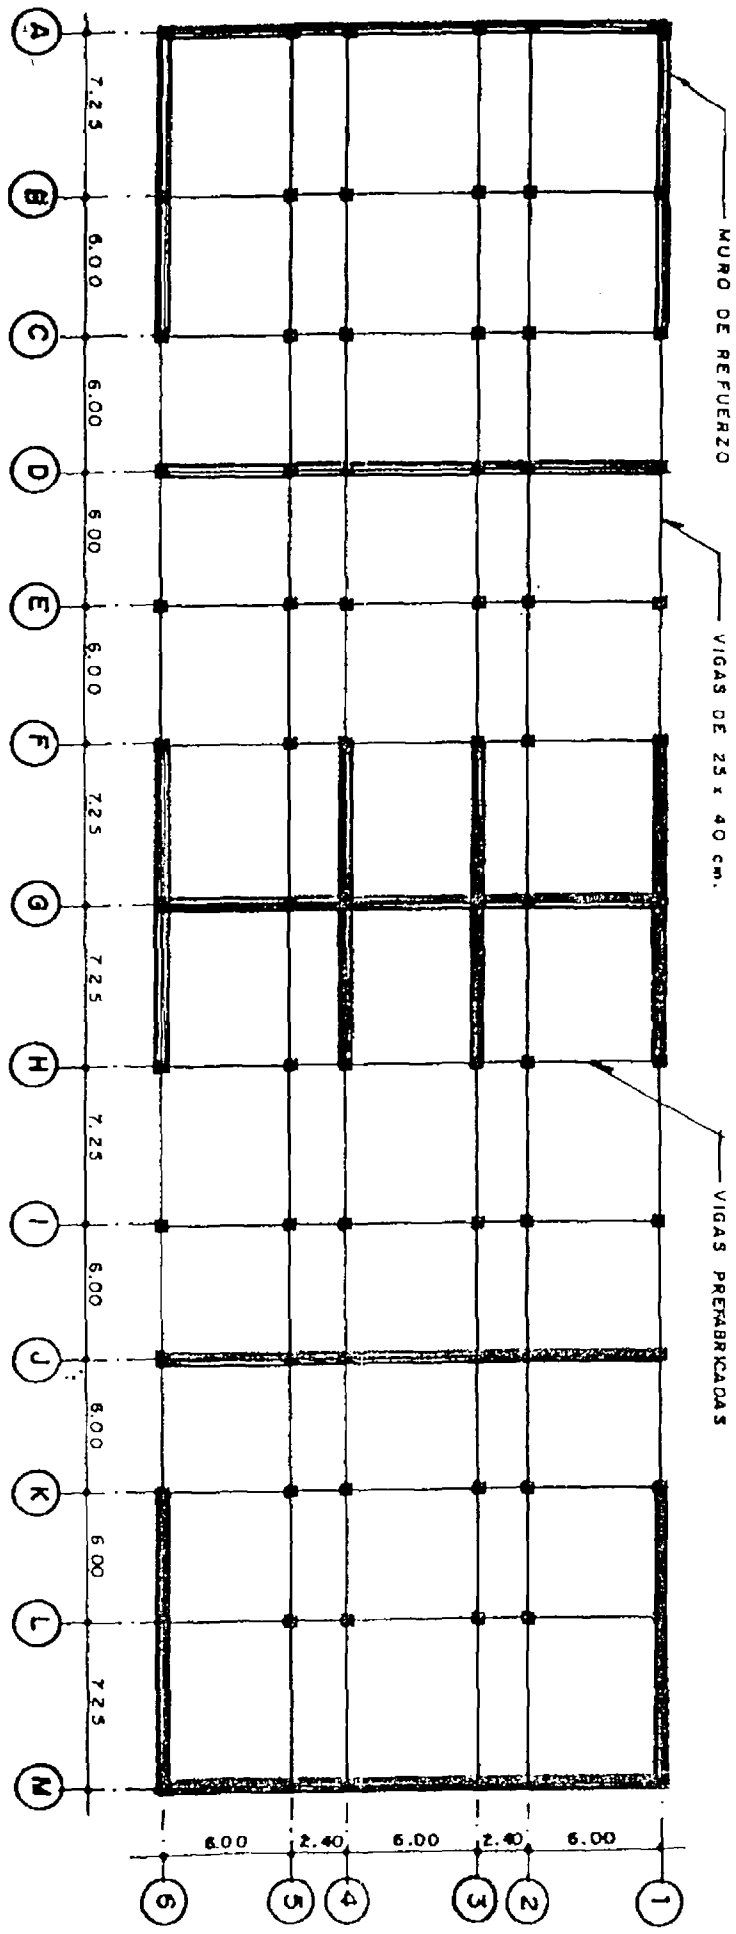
UBICACION DE MUROS DE MAMPOSTERIA REFORZADA EN EL NIVEL SUBPLANTA BAJA
